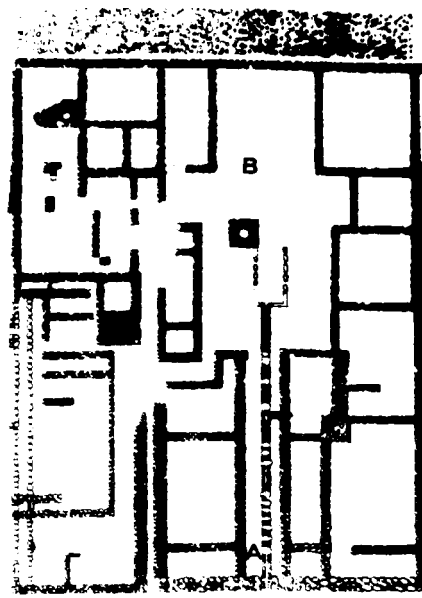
Marzabotto (BO), planimetria di una abitazione:
